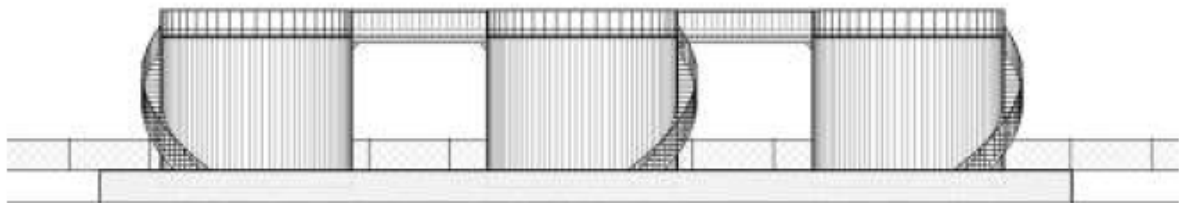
Nuovo deposito carburanti – schema planimetrico e prospettico tipo – fonte: Ente Gestore
